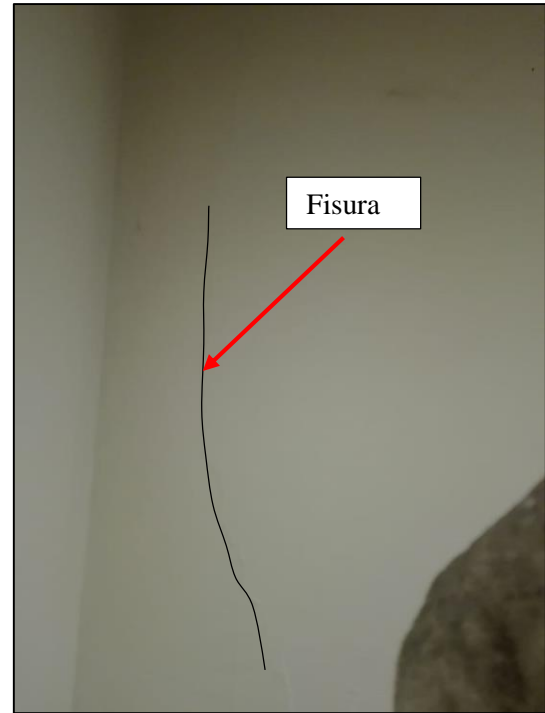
Vista de la fisura en la pared lateral de la Sala
